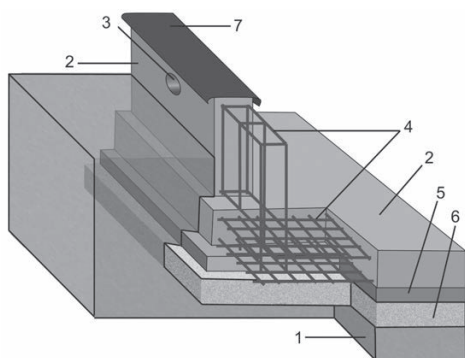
Монолитный плитный фундамент: 1 — грунт основания; 2 — монолитный бетон; 3 — асбестоцементная труба; 4 — арматурный каркас; 5 — бетонная подготовка; 6 — утрамбованная песчаная подушка; 7 — гидроизолирующий слой
